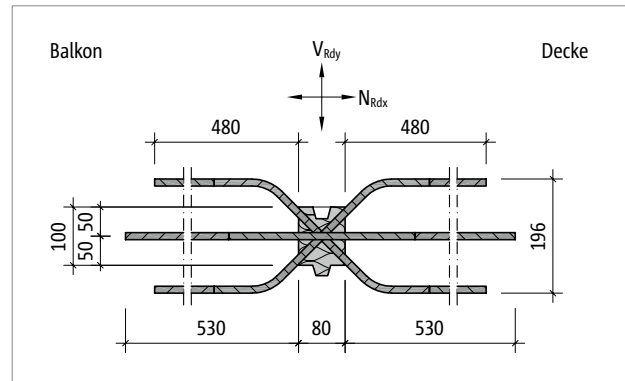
Schöck Isokorb® T Typ HP-VV2-NN1: Produktgrundriss
